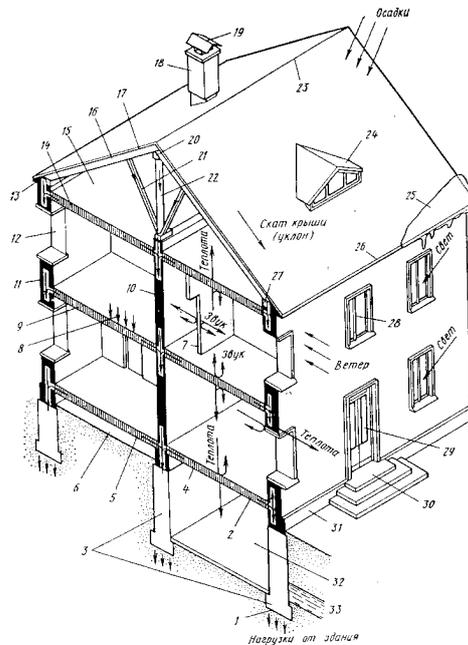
Основные конструктивные элементы здания с кирпичными несущими стенами: 1 – подовая фундаменты; 2 – полевые перегородки; 3 – фундаменты; 4 – потолок; 5 – лицевые перегородки; 6 – водосток; 7 – перегородка; 8 – нагрузка от собственной массы, людей и оборудования; 9 – междуэтажное перекрытие; 10 – продольная внутренняя стена; 11 – стена; 12 – оконный проем; 13 – накат; 14 – чердачное перекрытие; 15 – чердак; 16 – стропильная балка; 17 – кровля; 18 – дымоходная труба; 19 – вент; 20 – козырьковый прогон; 21 – поддон; 22 – стойка; 23 – козел; 24 – слуховое окно; 25 – свет; 26 – ларь; 27 – мазулет; 28 – оконный перелет; 29 – дверное полотно; 30 – крыльцо; 31 – цоколь; 32 – подвал; 33 – грунтовая влага
